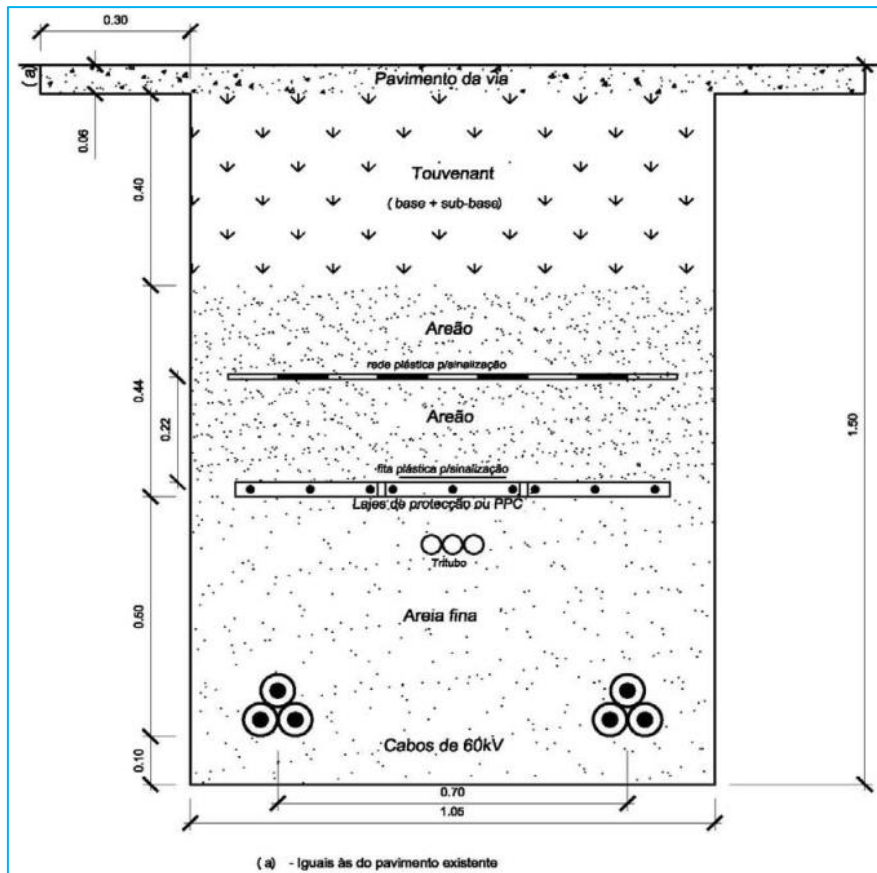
Pormenor de instalação de cabos de 60 kV em pavimento [43]
